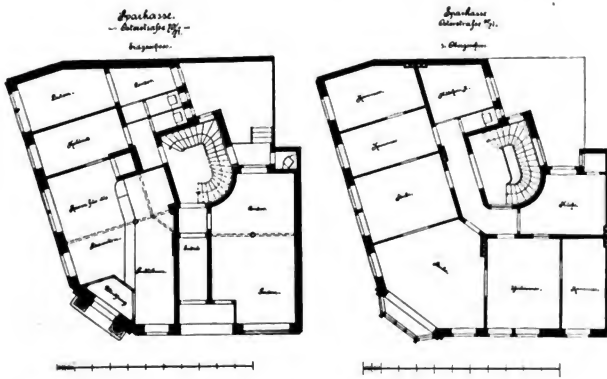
und 383. Grundriß der beiden Hauptgeschosse der Sparkasse am Buntenthor. Klingenberg und Weber. 1897.
